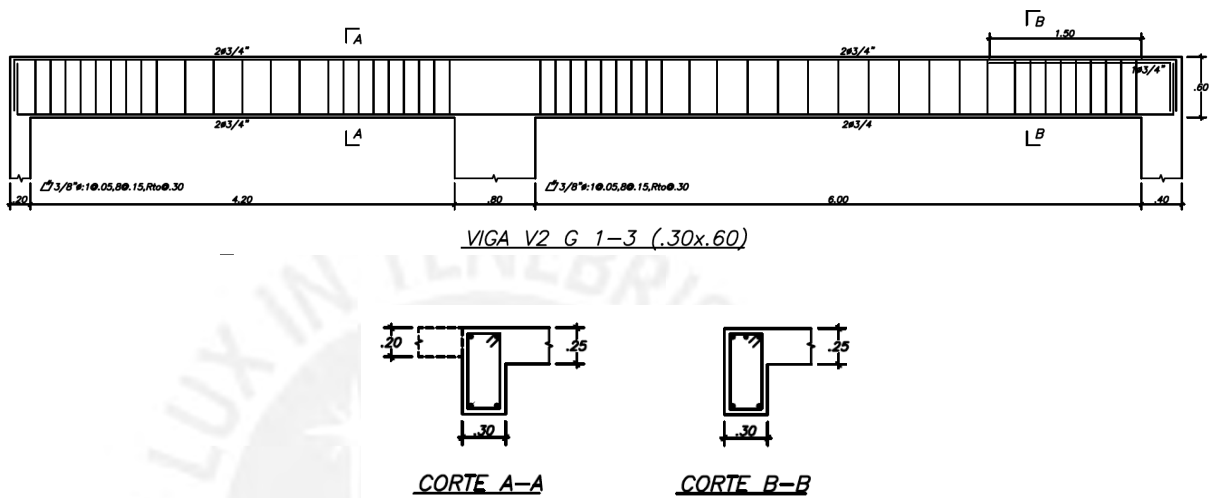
Diseño Final Viga “V2 G 1-3”
